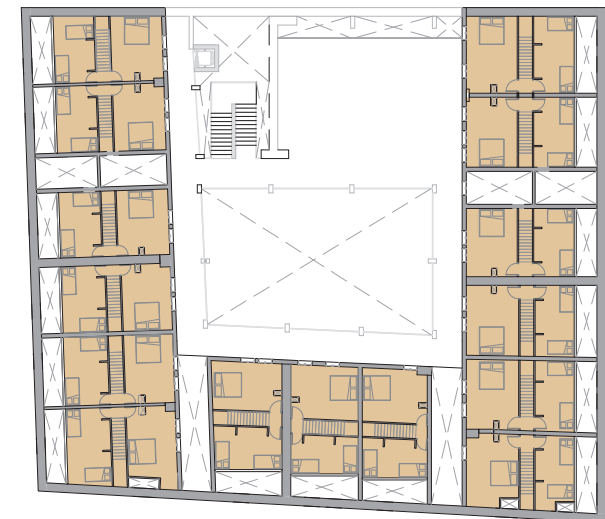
Planta alta departamento dúplex Tipo B para cuatro personas
